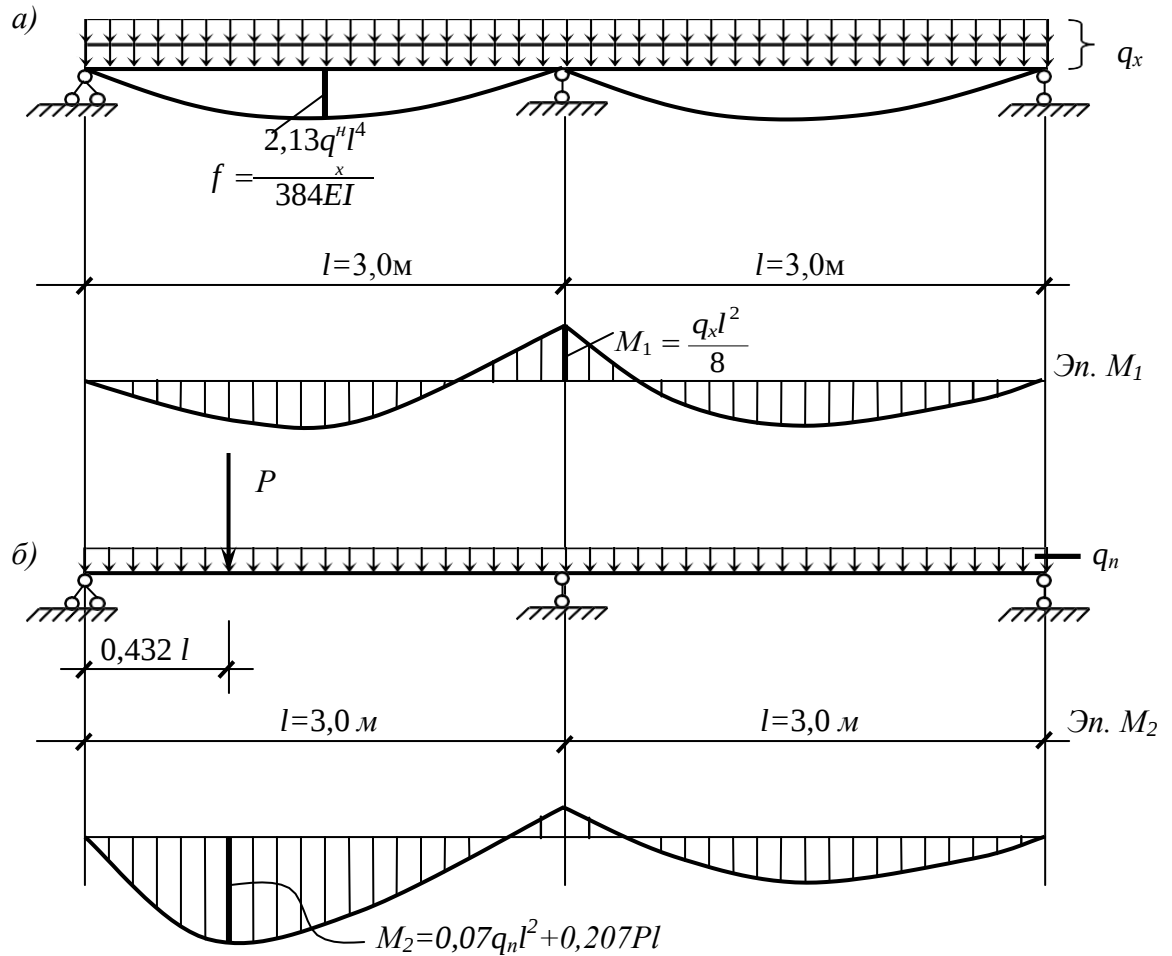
Расчетные схемы настила и эпюры M : a – при первом сочетании нагрузок, b – при втором сочетании нагрузок
